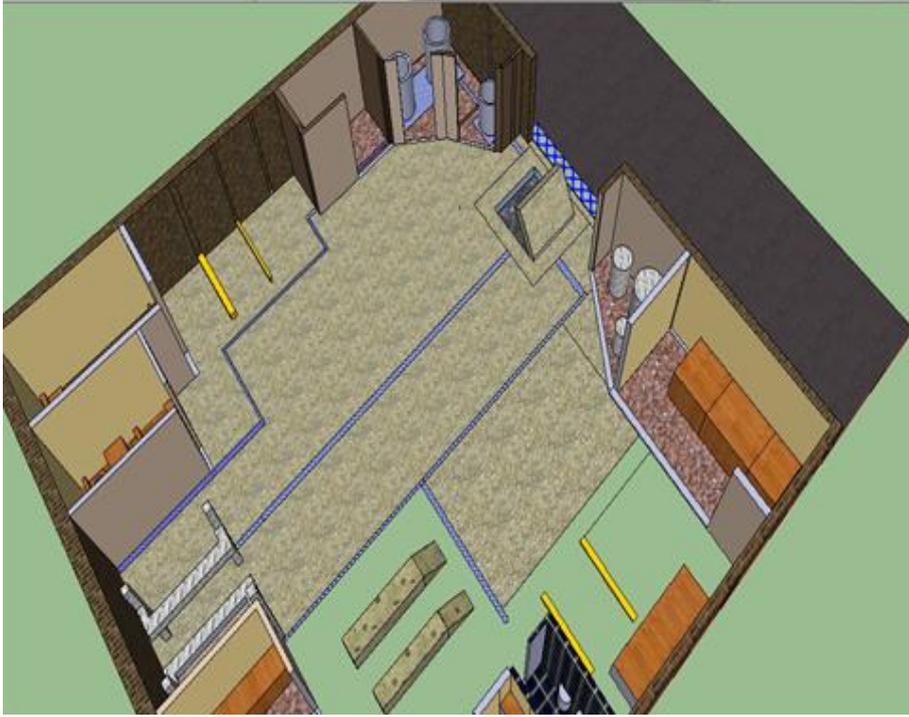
sistema colector en vista superior izquierda. Fuente, autor
